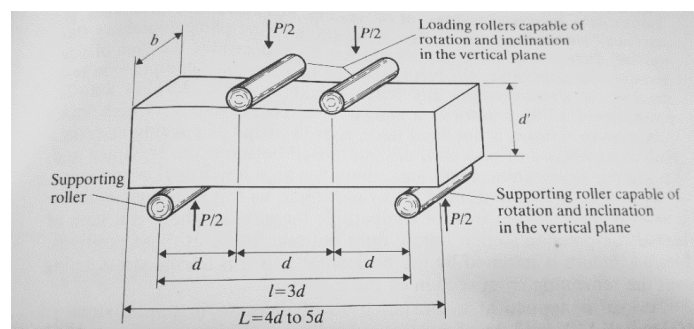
Arreglo de cargas para prueba a flexión de una viga de concreto.¹³⁵
